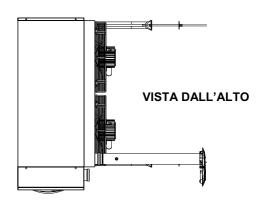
Installazione tipo C33 coassiale a tetto c/tubi Ø 130
